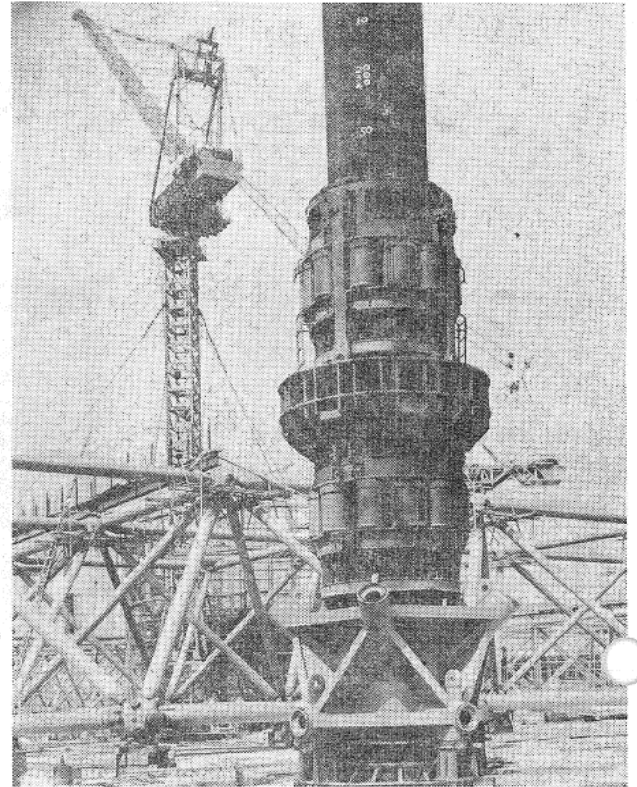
主柱に挿入された下から Structure Ring, Lower De LONG Jack, Ring Girder, Upper De LONG Jack. 遠景の Tower Crane は太陽の塔工事用のもの。
